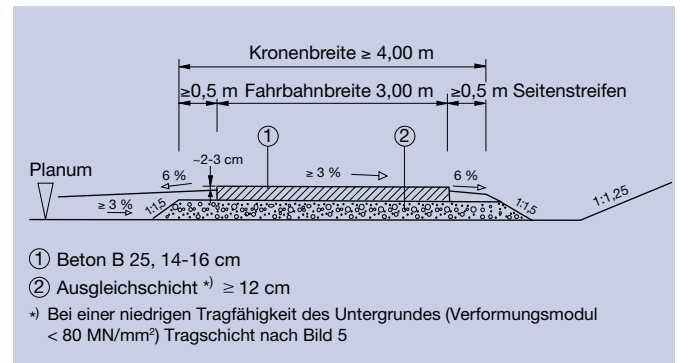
Regelquerschnitt eines Wirtschaftsweges mit Betondecke
